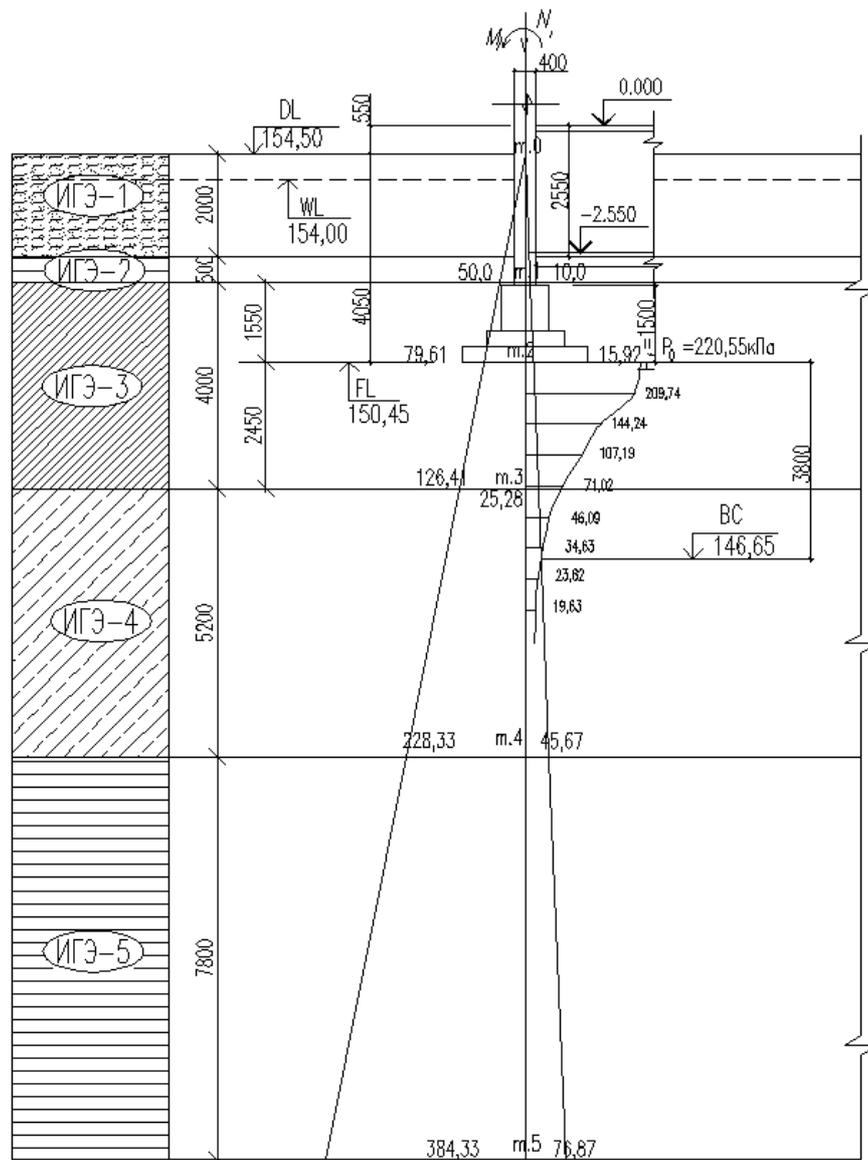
К расчету осадки фундамента ФМЗ-2 в сечении I - I.
